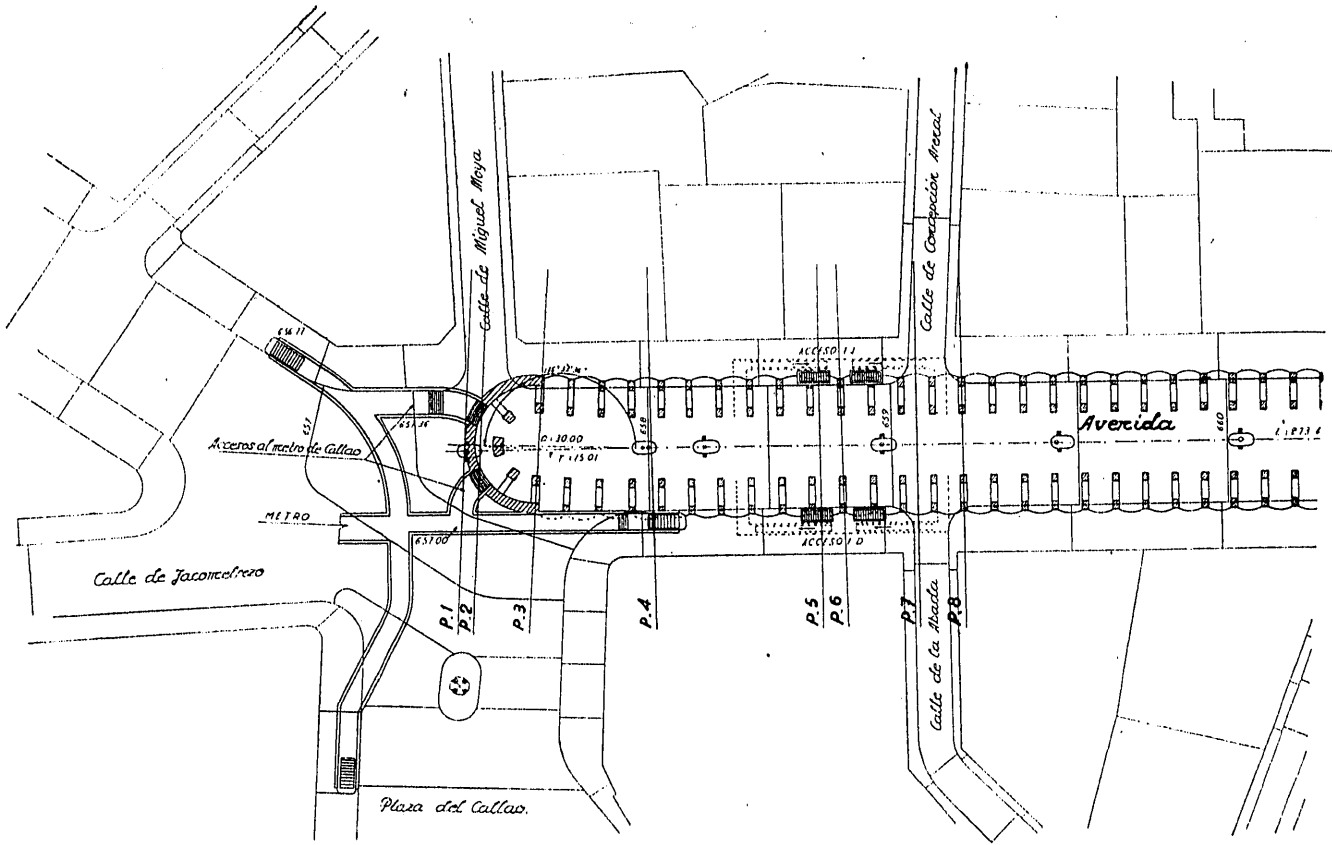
^a — Parcial de la planta de Subavenida, extremo de Callao. Se señalan cuatro escaleras mecánicas de acceso.
